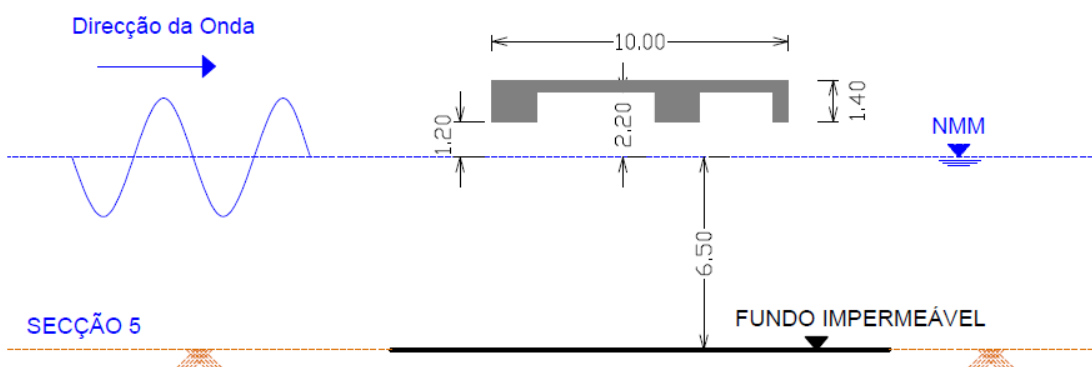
Secção transversal 5 da Ponte-Cais e respectivas dimensões em metros.
